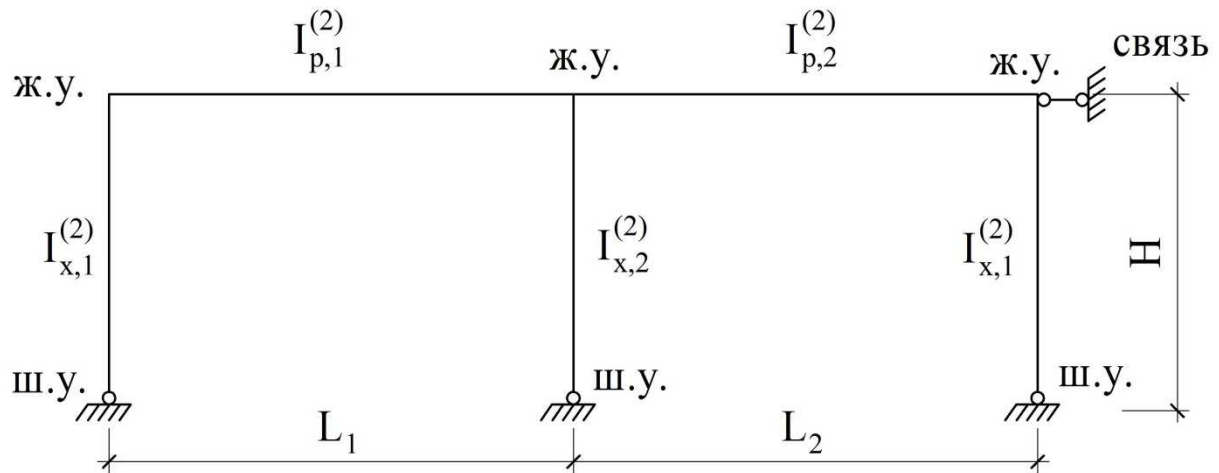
Расчетная схема двухпролетной несвободной поперечной рамы: верхние узлы - жесткие; нижние узлы - шарнирные; поперечные сечения колонн - постоянные; ригеля - эквивалентные стержни
